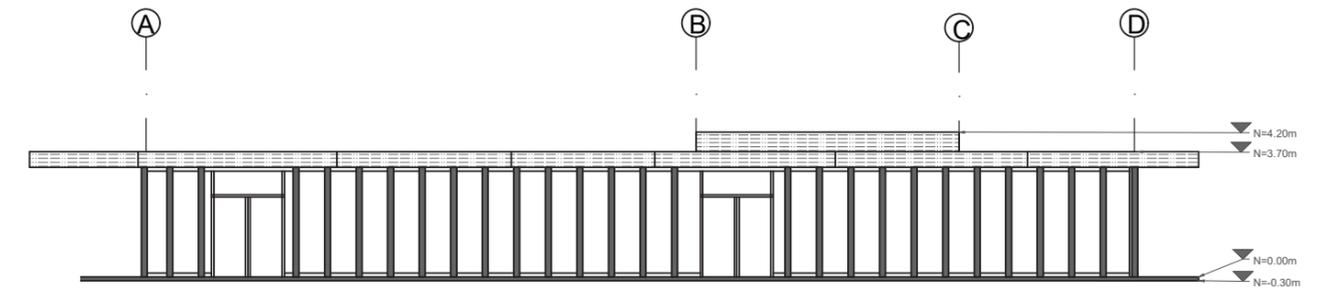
PLANIMETRÍA\_ELEVACIÓN LAT. IZQUIERDA
